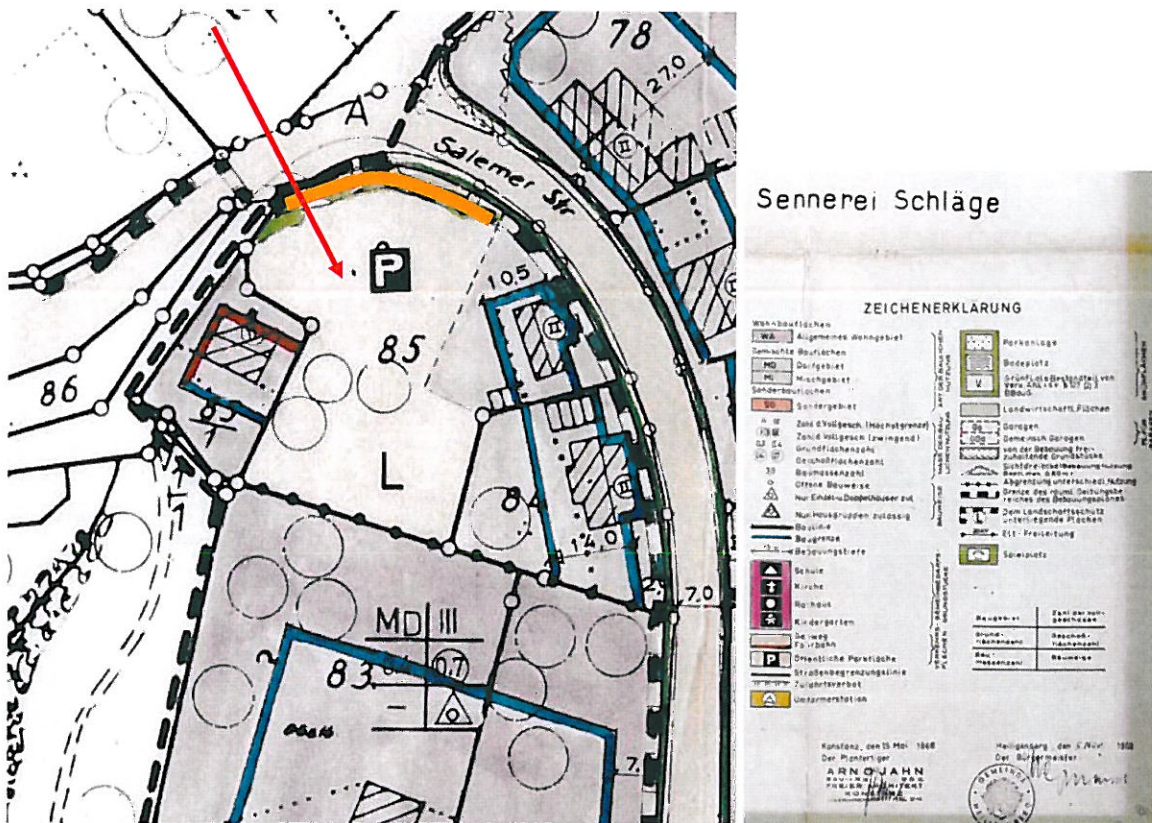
Bebauungsplan Ortsetter, Heiligenberg
